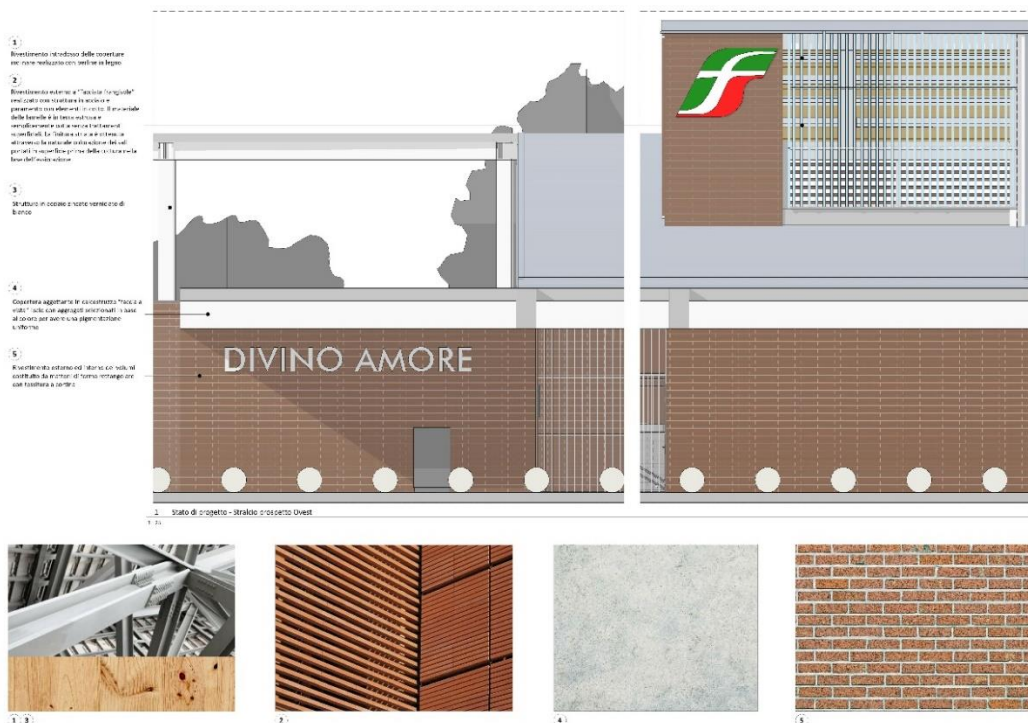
Stralcio di prospetto con riferimenti dei materiali
